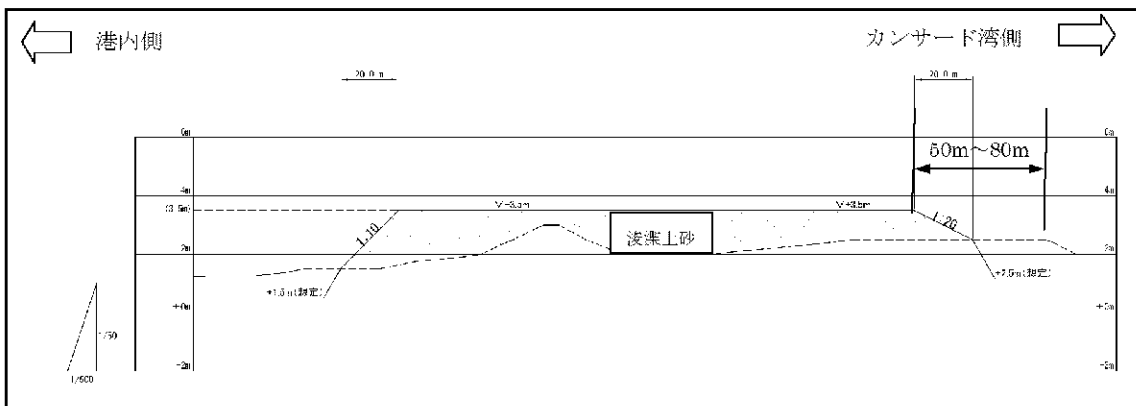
(12) 浚渫土砂の敷き均し C-C 断面図
